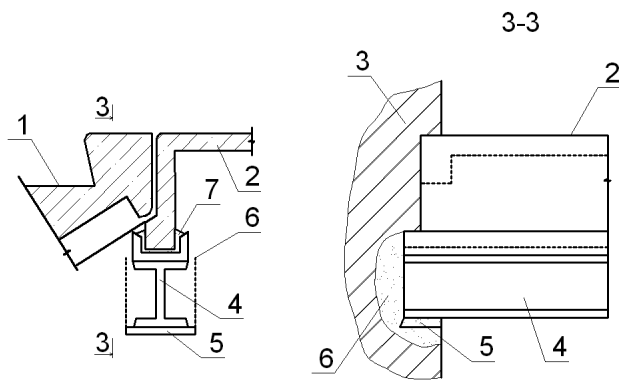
Підведення розвантажувальних балок під лобове ребро сходової площадки:
